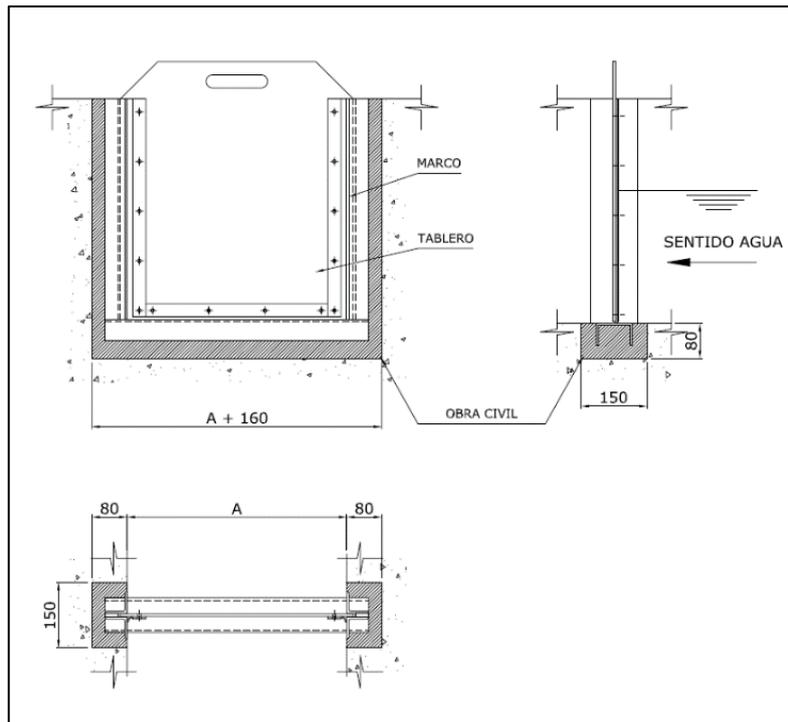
Esquema de la compuerta de tajadera (Fuente: TECMONCADE).
